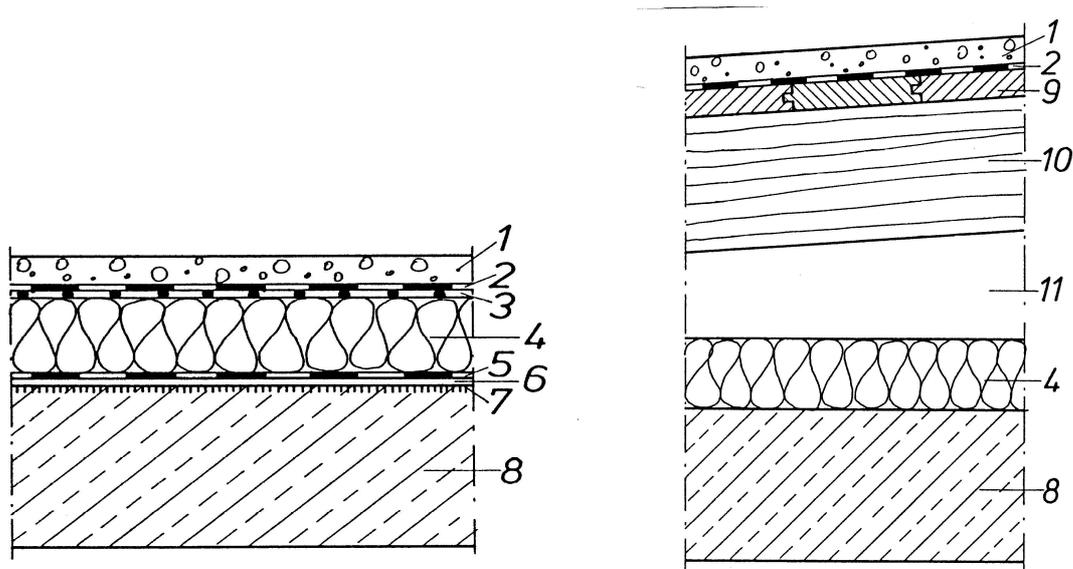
a) nichtbelüftetes Dach, b) belüftetes Dach
